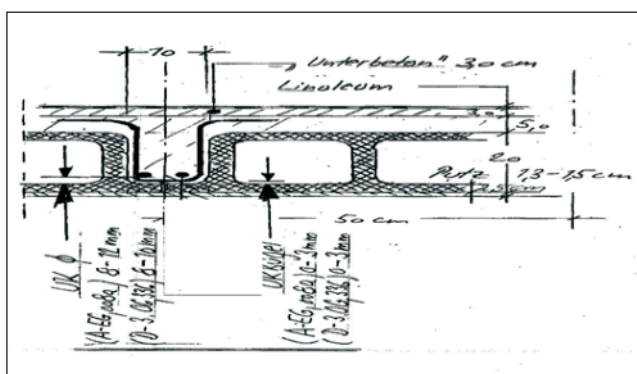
Querschnitt einer Stahlbetonrippendecke mit Schalkörpern
